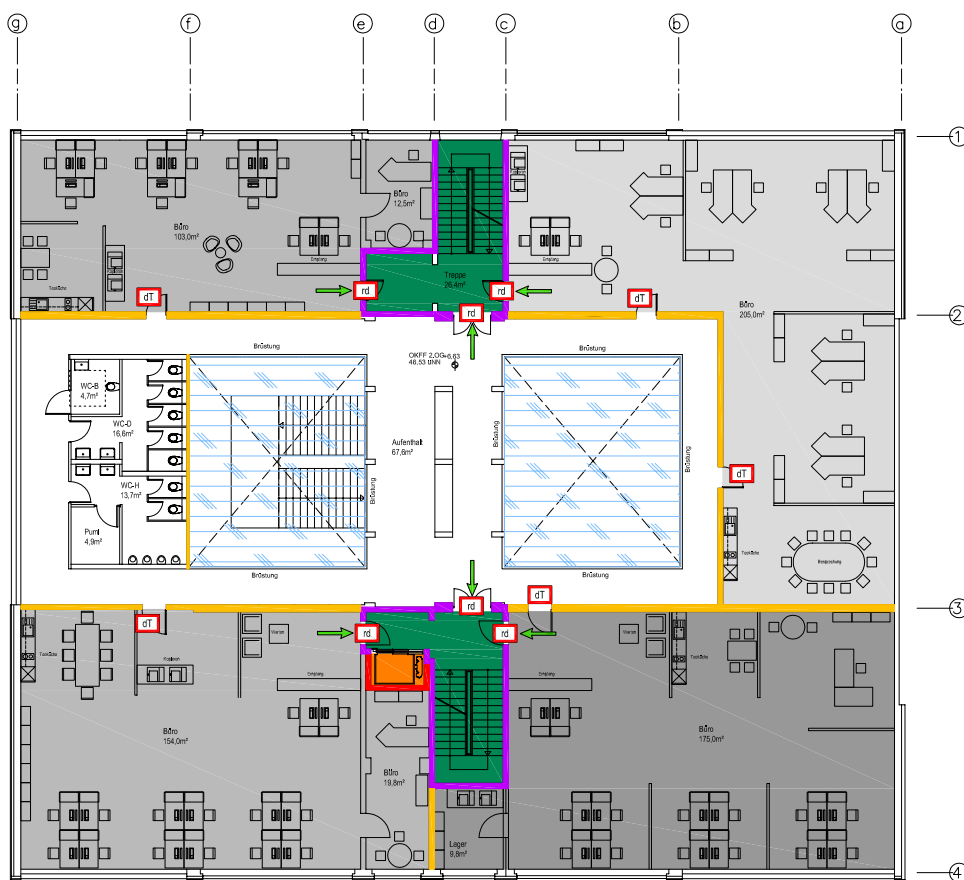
Grundriss 2. OG des Verwaltungsgebäudes
